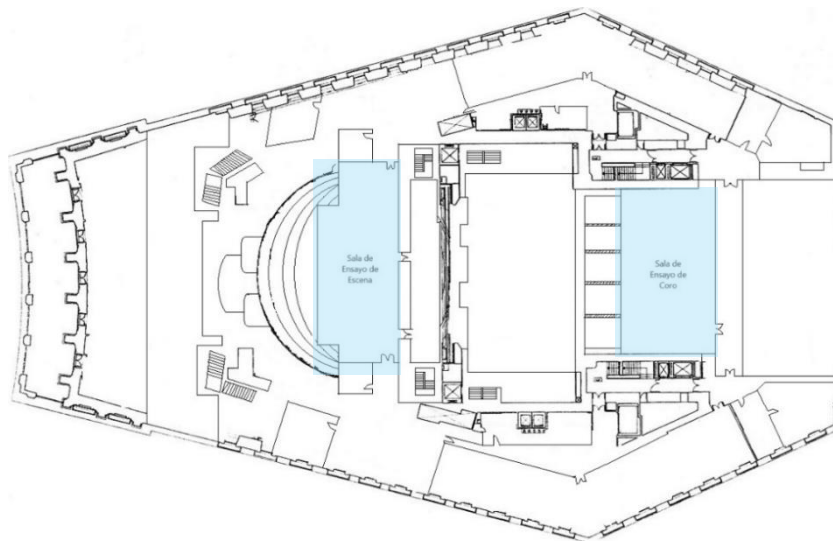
Planta 8: Salas de ensayo de coro y escena [13]
